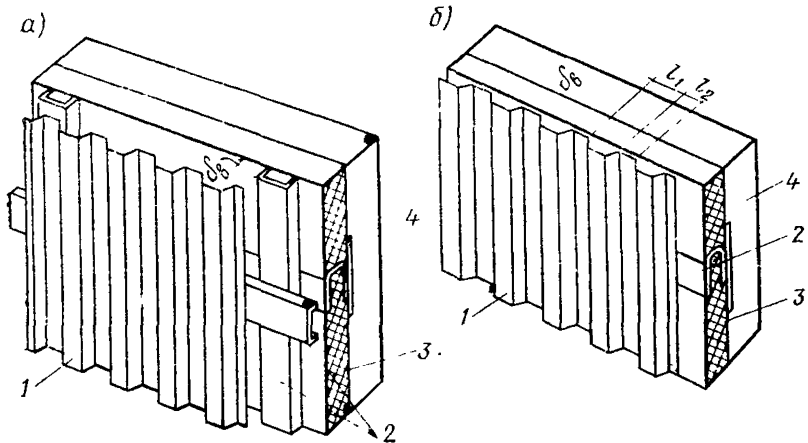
Вентилируемая стена 1-го типа с защитным экраном с наружной стороны
